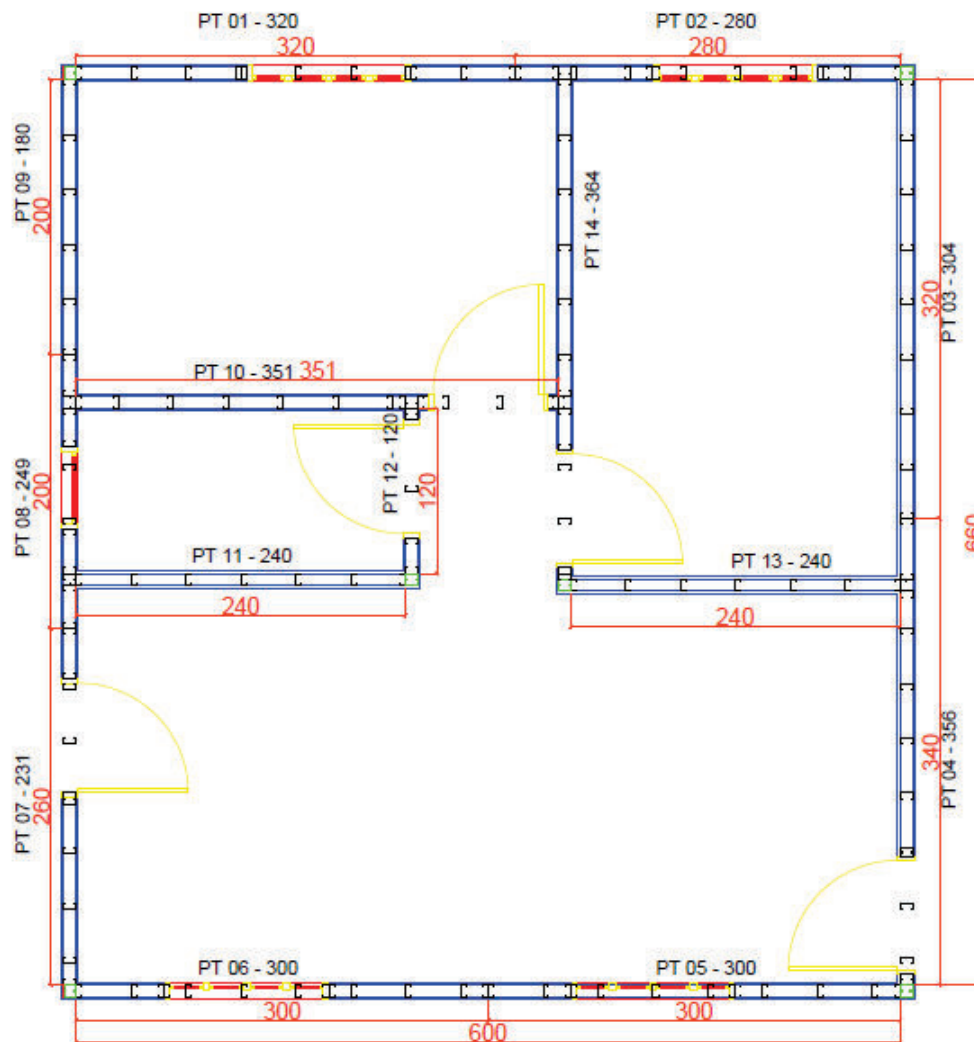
Detalhamento viga baldrame: Alvenaria estrutural
